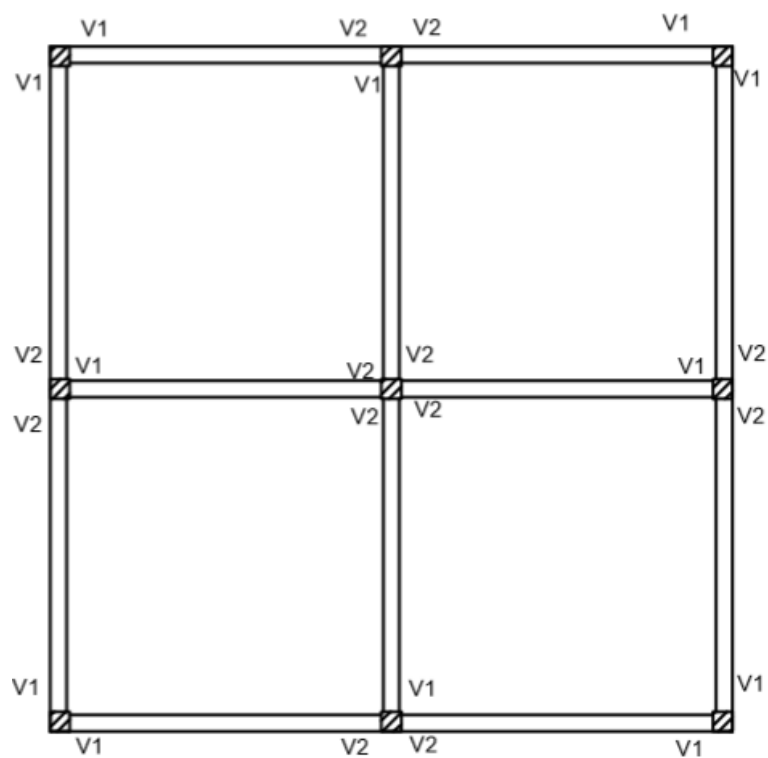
Planta do primeiro piso do Edifício 2.
